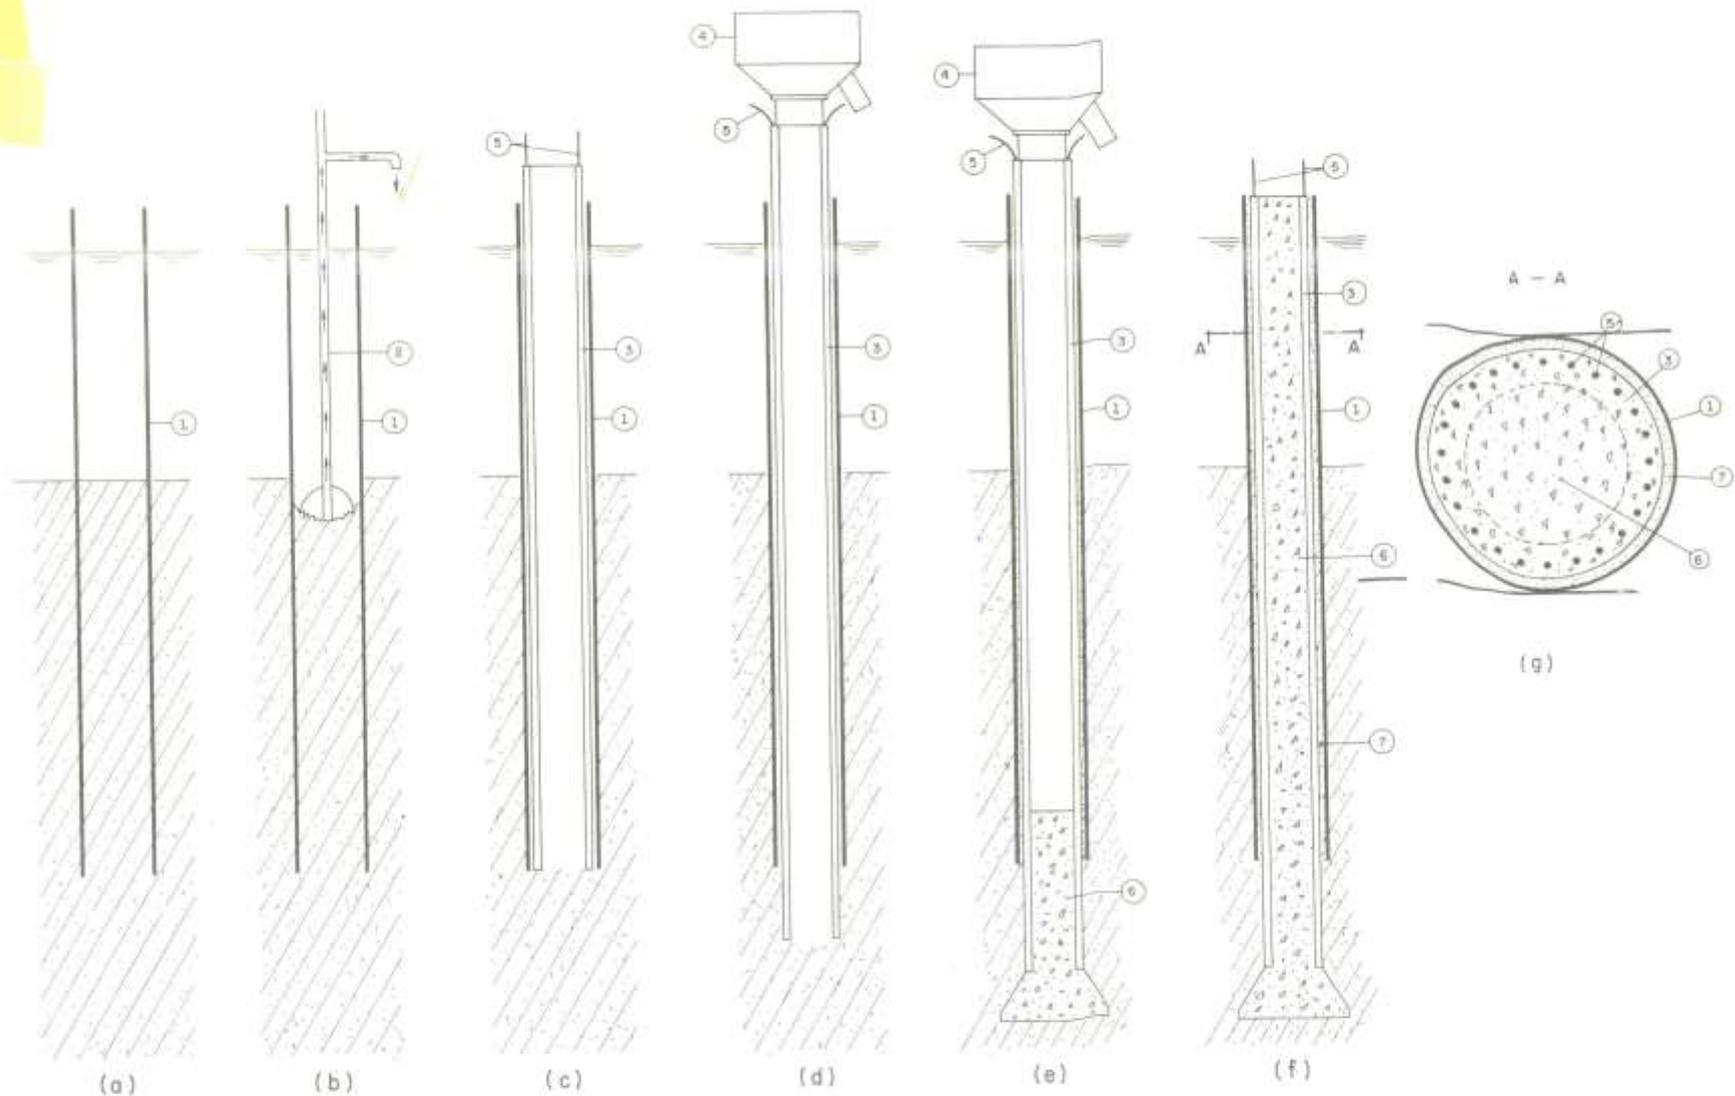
Tubulão a ar comprimido com escavação tubada prévia: a) camisa metálica (1) cravada no solo; b) escavação no interior da camisa com equipamento provido de air-lift; c) tubulão de concreto armado parcialmente pré-moldado (3), com armação (5), colocado no interior da camisa metálica (1); d) escavação a ar comprimido no interior do tubulão de concreto, com auxílio de campânula (4); e) concretagem da base alargada e parte do fuste (6) sob ar comprimido; f) conclusão da concretagem a céu aberto (6), enchimento de areia (7) entre o tubulão e a camisa.
